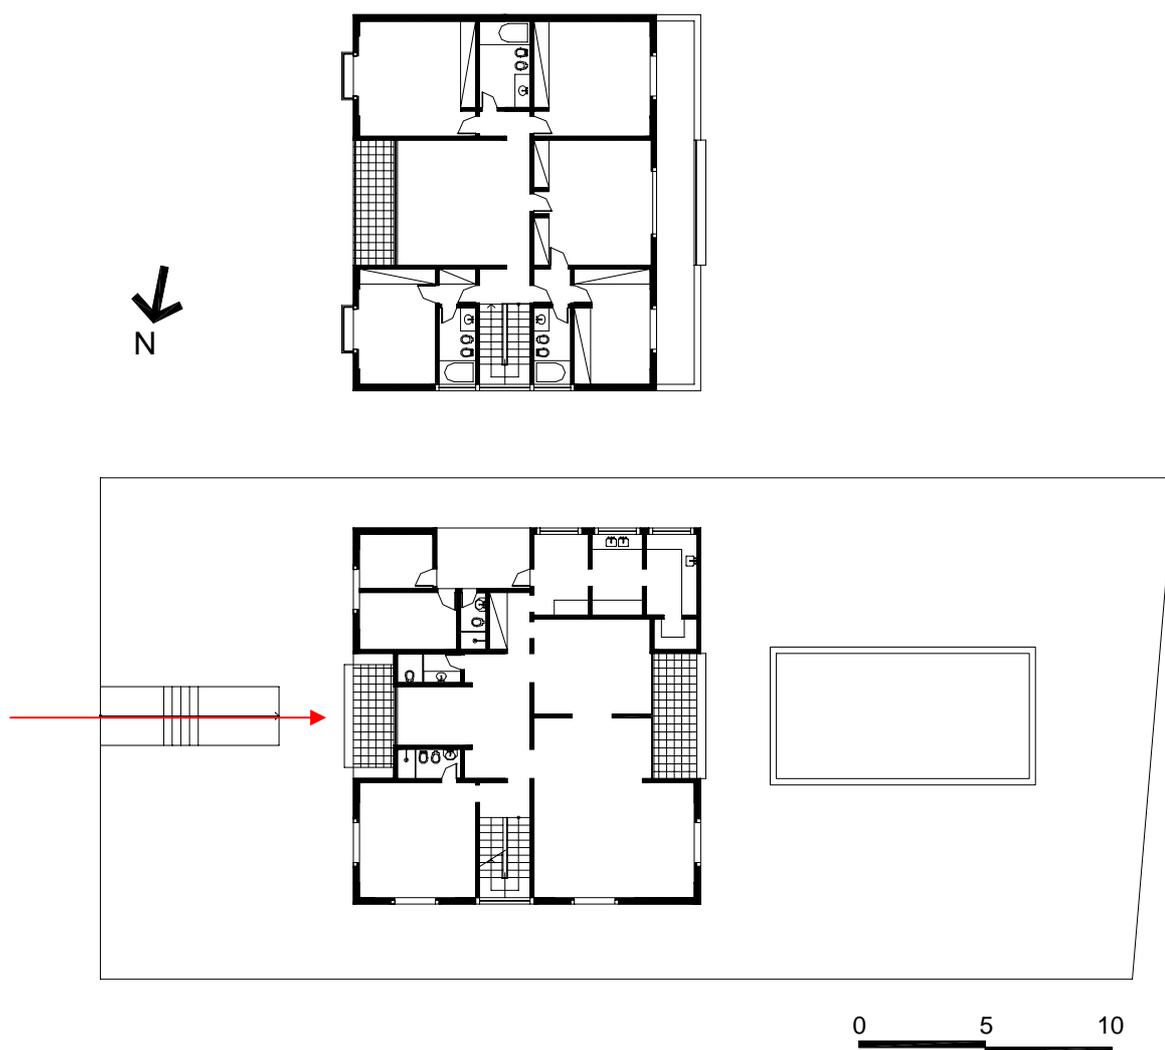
e 43: Plantas da Casa de Brasília. De baixo para cima: Pavimento térreo e pavimento superior. (Desenhos da autora, a partir de plantas do acervo da "Coleção Bolonha" - NPD/FAU/UFRJ).
